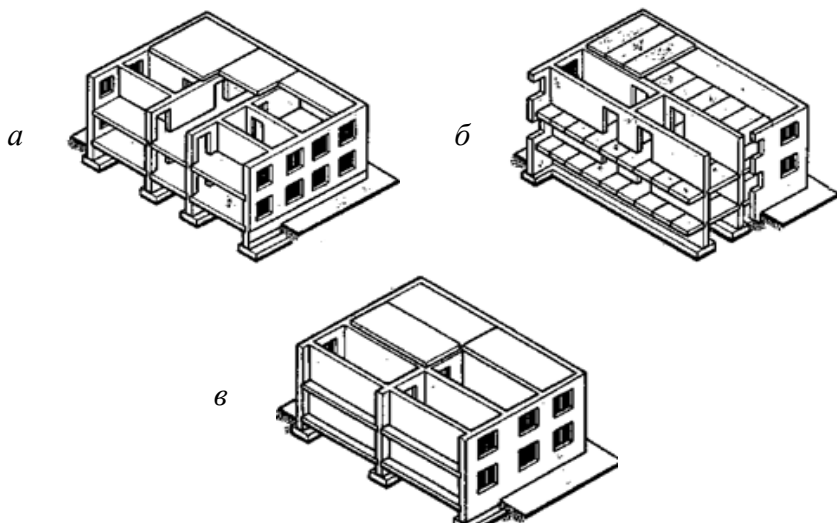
Конструктивные схемы бескаркасных зданий:
